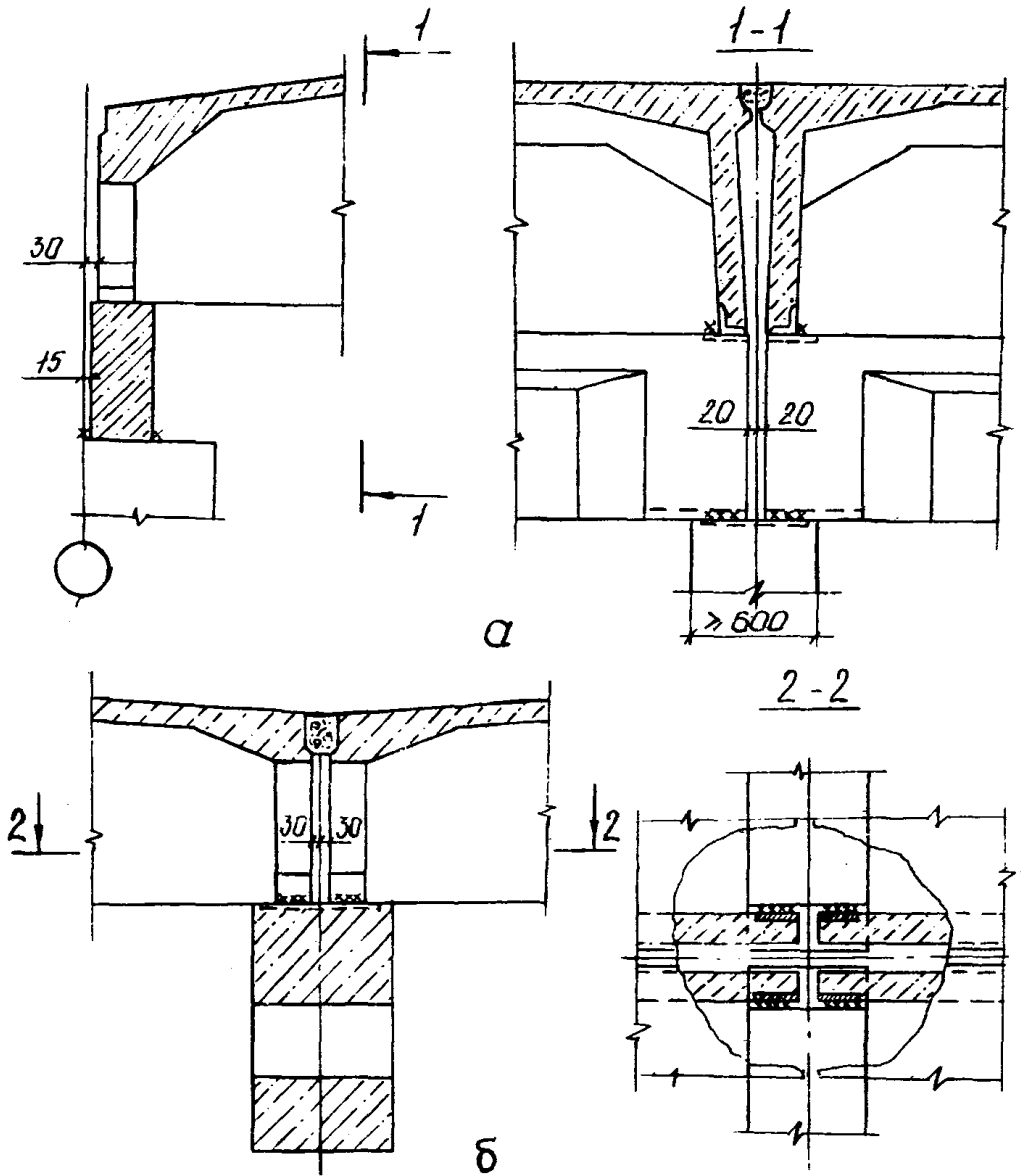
Узлы крепления панелей-оболочек КСО к продольным конструкциям
